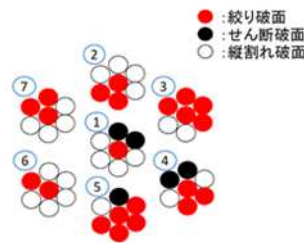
I-3 F70TA 破断面状況 図-5 D-13 F70TA 破断面状況
